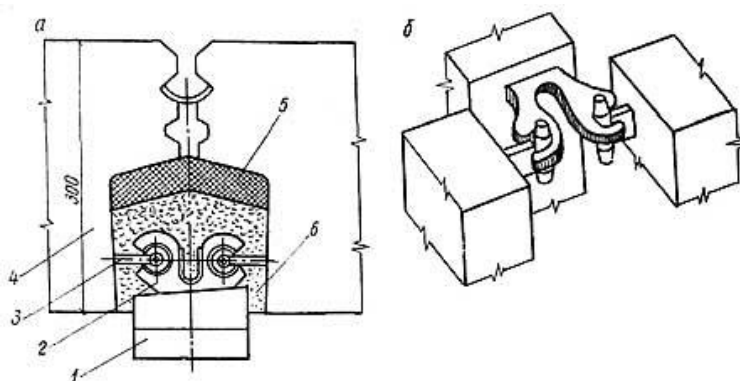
Замковое соединение панелей: а — соединение внутренней и наружной панели; б — схема замковых соединений; 1 — панель внутренней стены; 2 —
